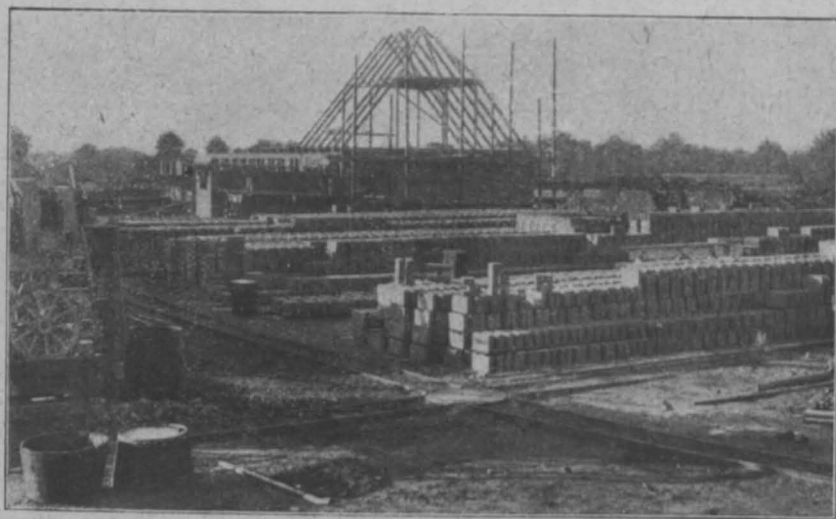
Ausführung der Bauten in Langenhorn bei Hamburg.
